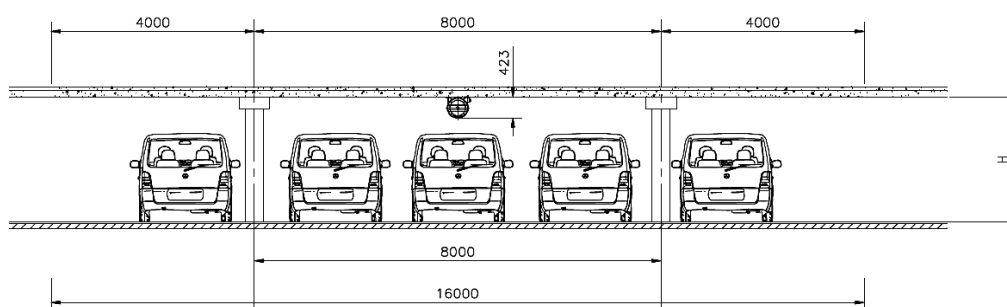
Расположение автомашин вдоль вентиляционного воздушного потока и струйных вентиляторов над парковочными местами
